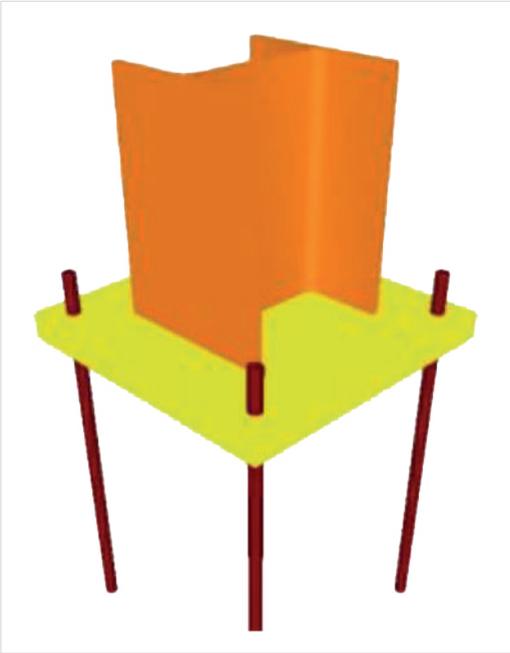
Pilar metálico Nivel de desarrollo 350. Fuente: BIM Forum 2013, B 1010.10\_Floor Structural Frame\_Steel Framing Columns
